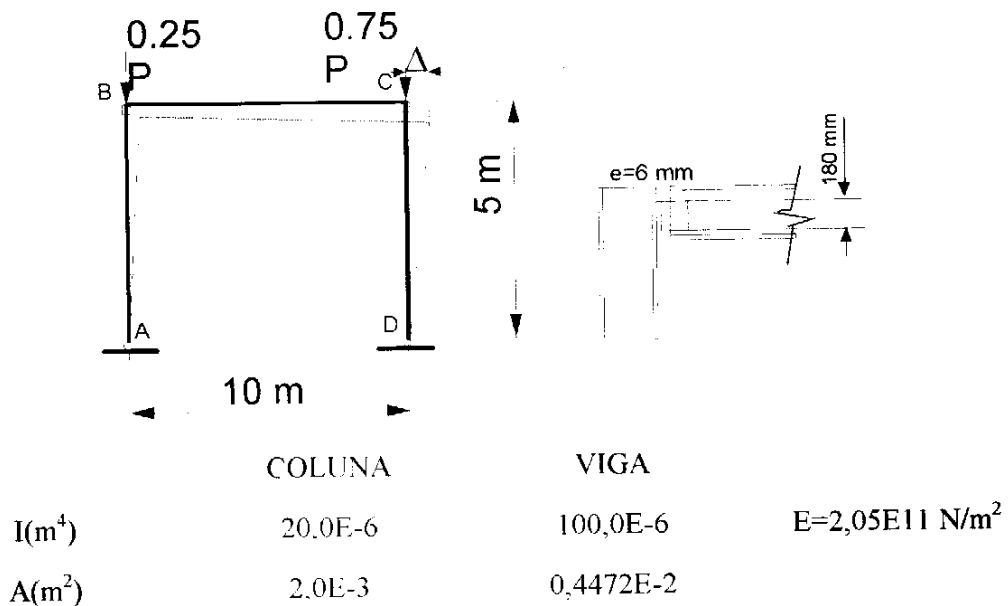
EXEMPLO I - Pórtico plano metálico com ligações semi-rígidas.
